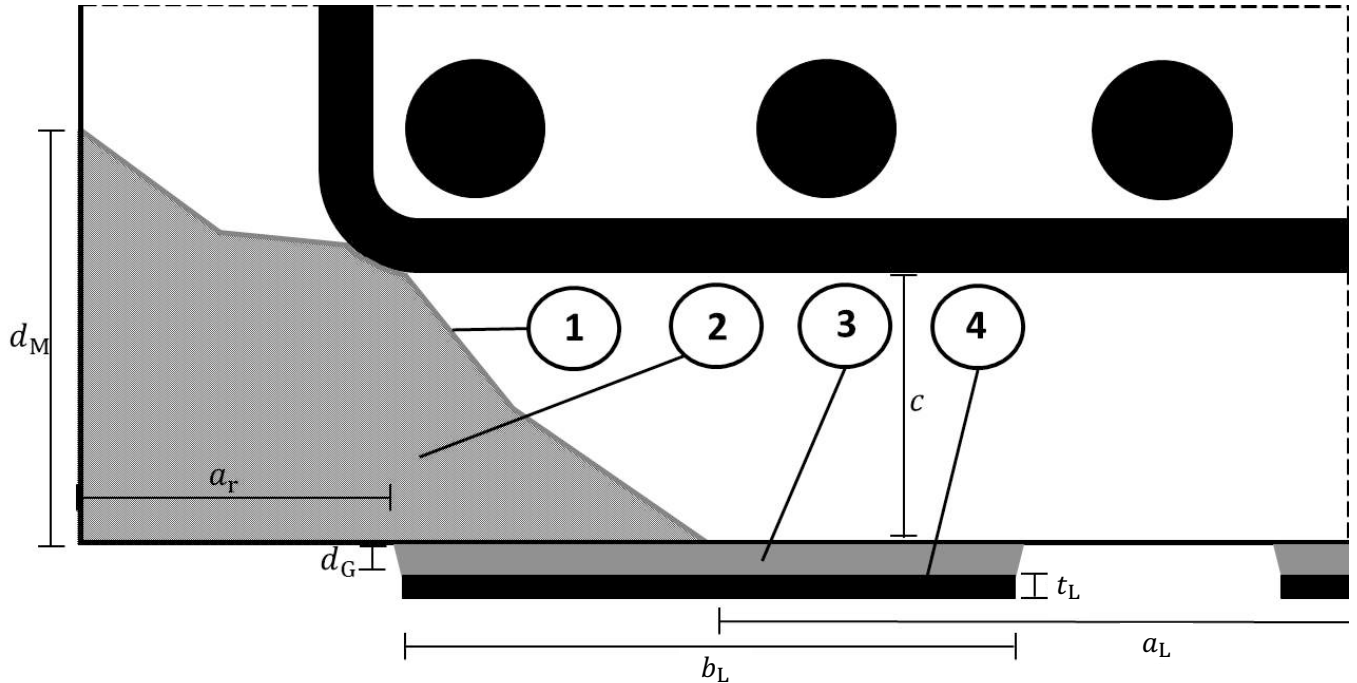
Querschnitt eines Stahlbetonbauteils verstärkt mit schubfest auf die Oberfläche geklebten FRS-L-S und FRS-L-H CFK-Lamellen mit Epoxidharzklebstoff FRS-CS und (optionaler) vorangegangener Betonreparatur mit dem Betonersatzsystem FRS-PC 11 mit der Haftbrücke FRS-BA.
